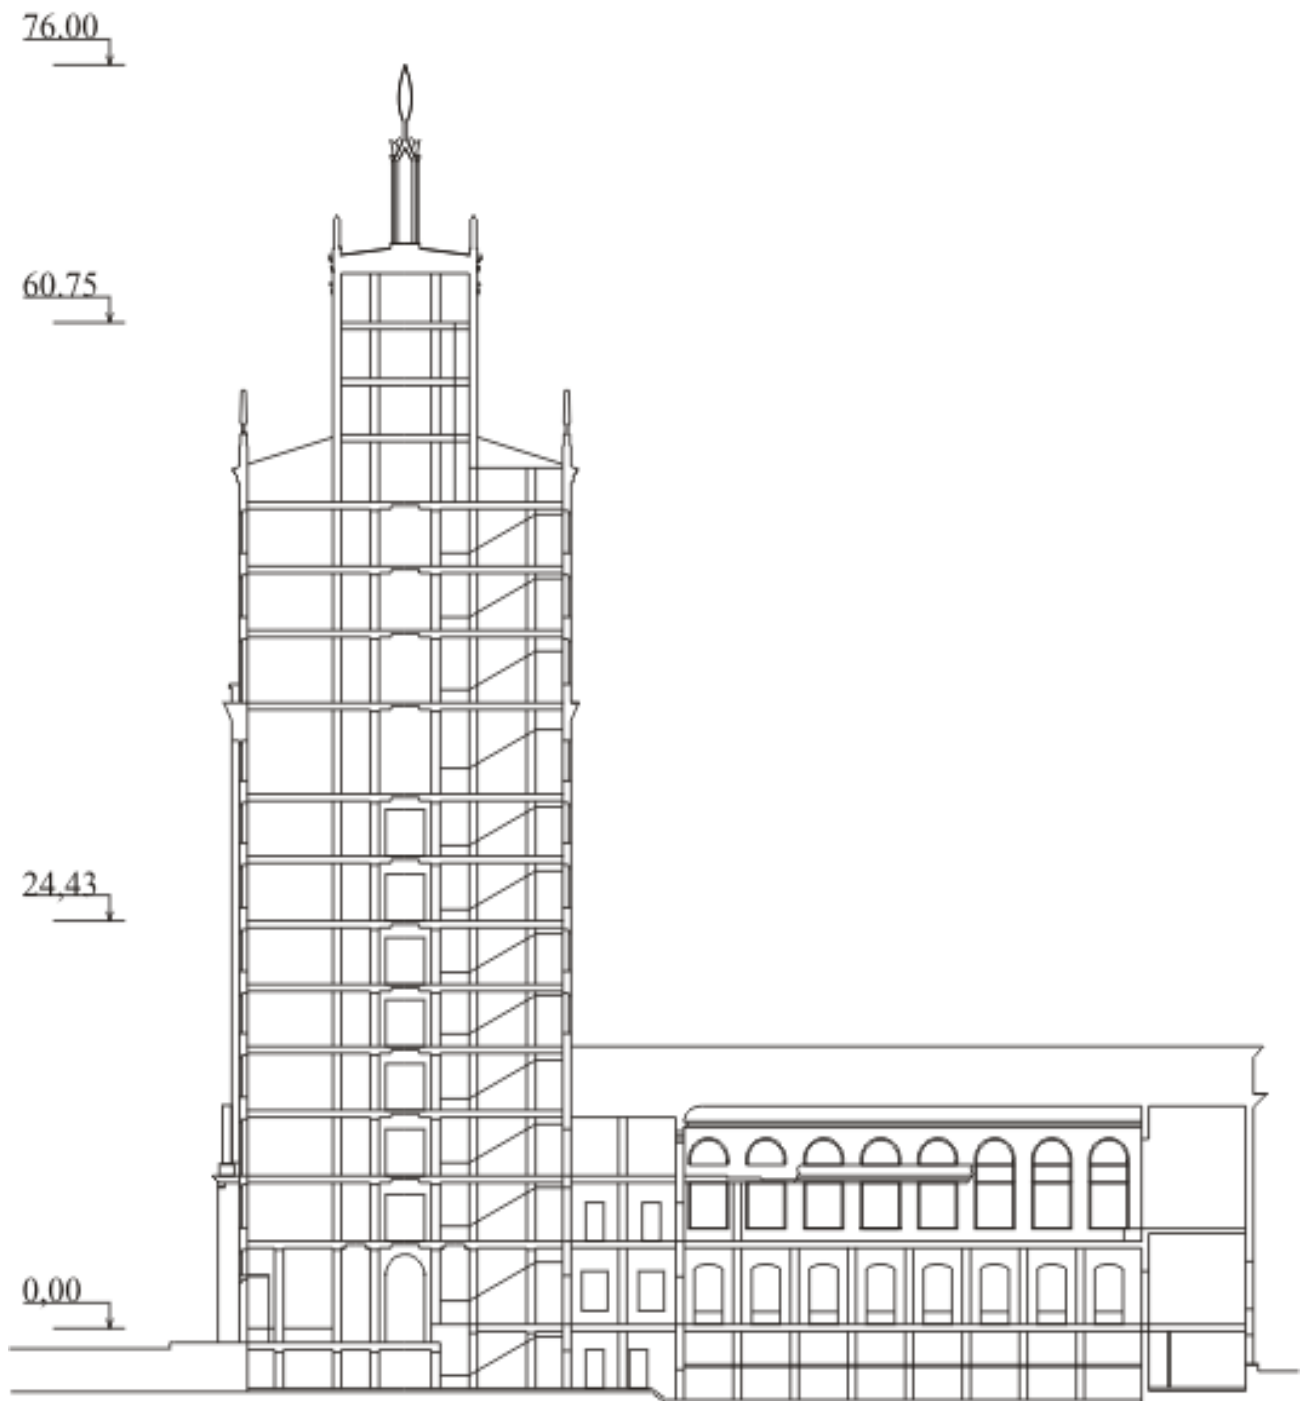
Поперечный разрез центральной части главного корпуса университета (1951 г., ГИПРОВУЗ)
